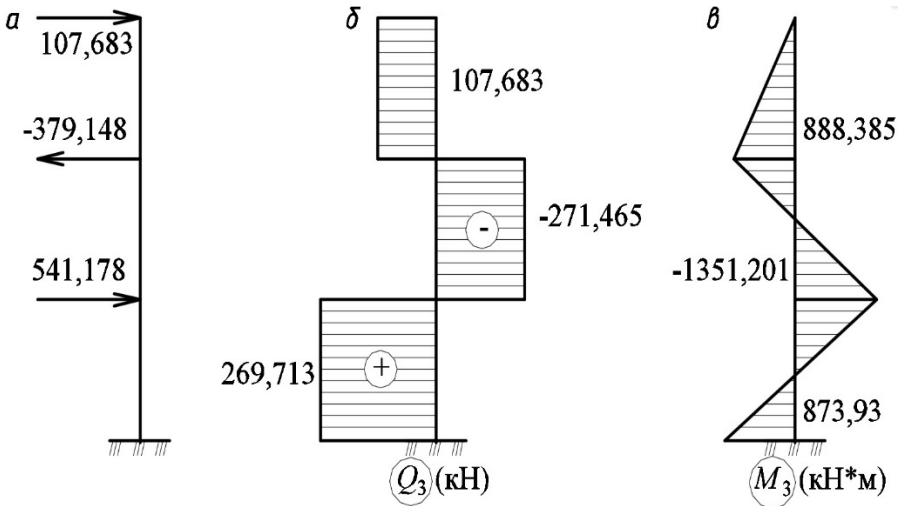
Нагрузки и эпюры внутренних усилий по третьей форме колебаний: *a* – схема приложения нагрузки; *б* – эпюра поперечных сил; *в* – эпюра изгибающих моментов
